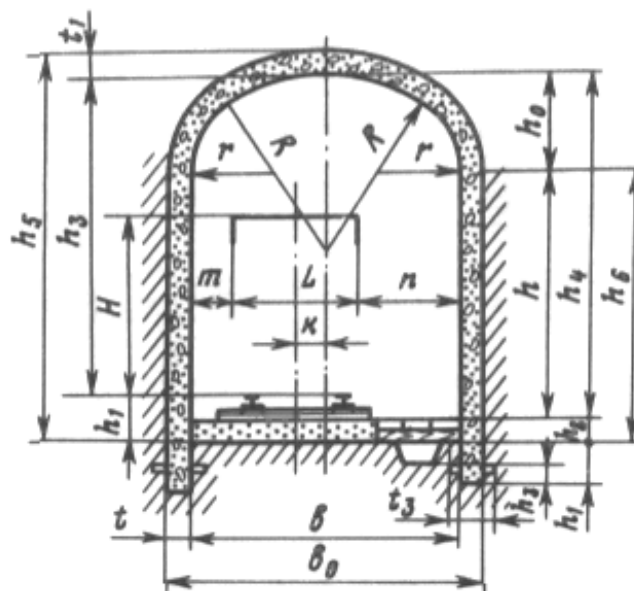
Типовое сечение однопутной выработки с монолитной бетонной крепью и локомотивной откаткой породы
